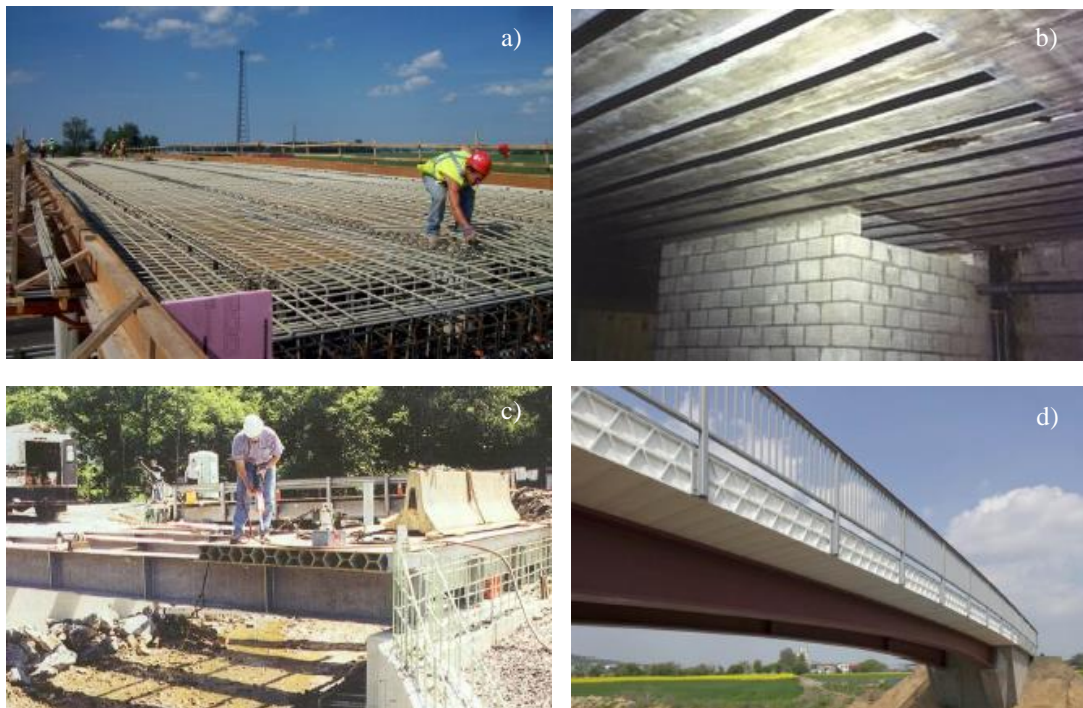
Exemplos das principais aplicações de materiais FRP em engenharia civil: a) armaduras interiores do tabuleiro de uma ponte; b) reforço de uma laje maciça vigada; c) reabilitação de uma ponte através de painéis pultrudidos; d) estrutura híbrida (Ponte de Friedberg, Alemanha) (adaptado de [2]).
